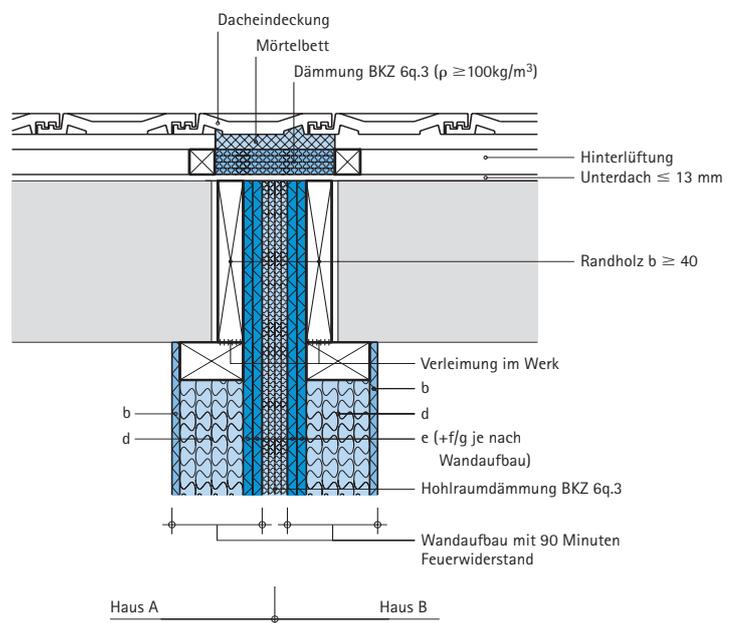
Dachkonstruktion liegt auf Brandmuerkonstruktion auf
